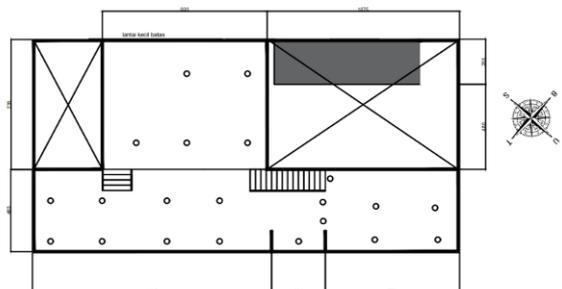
Lokasi titik pengukuran dan foto bukaan di Sumurboto Stationery di lantai 2
